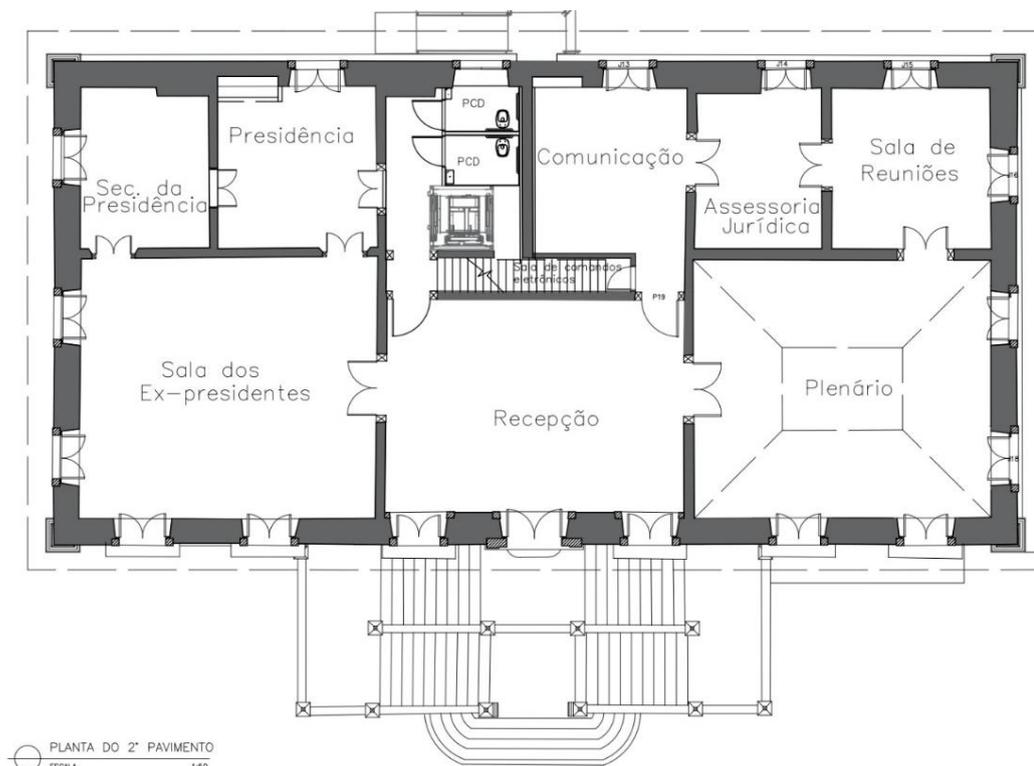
Planta do segundo pavimento da edificação após a restauração (2023)
